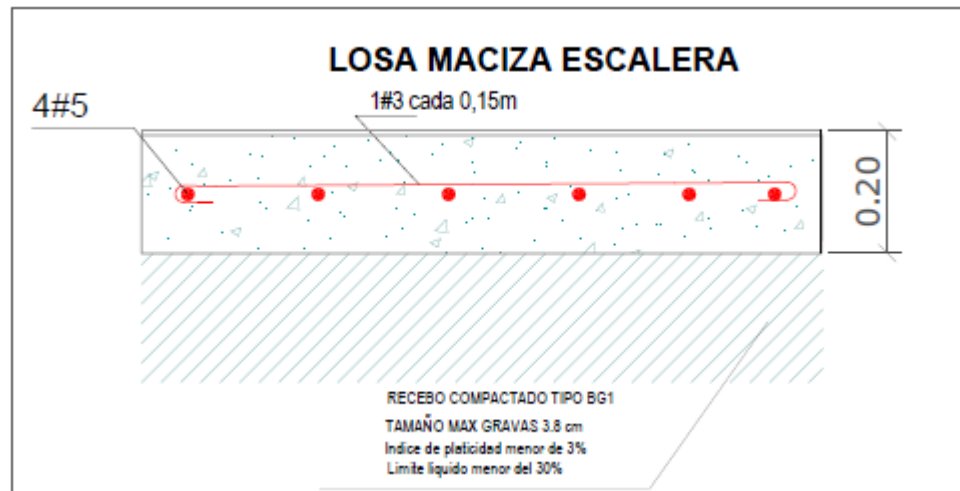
Sección de acero de refuerzo para la losa maciza de la escalera
